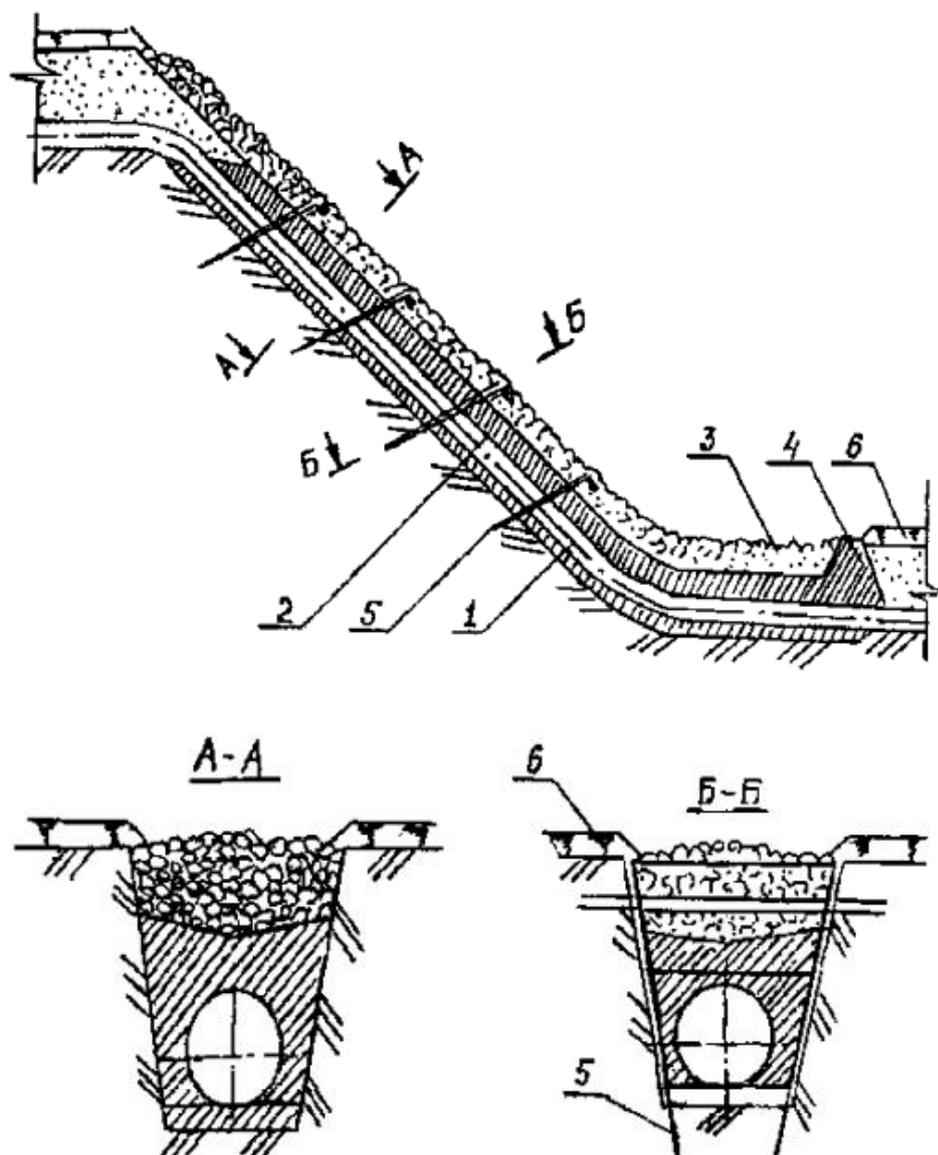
Траншейный дренаж на продольном склоне: 1 - трубопровод; 2- обсыпка из гидрофобизированного грунта; 3 - дренажная каменная наброска; 4 - перемычка из гидрофобизированного грунта; 5 – опорные водопроницаемые щиты; 6 - слой плодородного грунта с семенами трав
